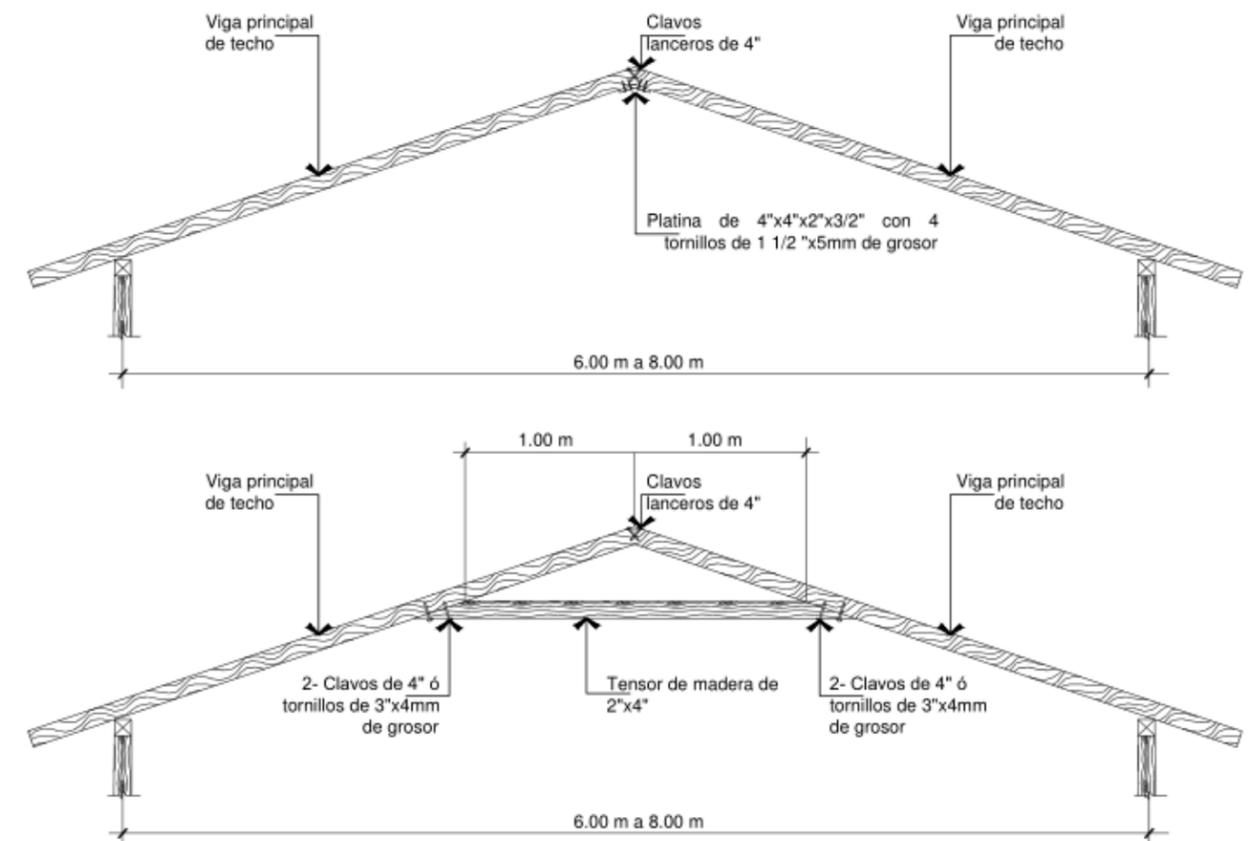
Techo en casa de madera. Fuente: equipo de trabajo
